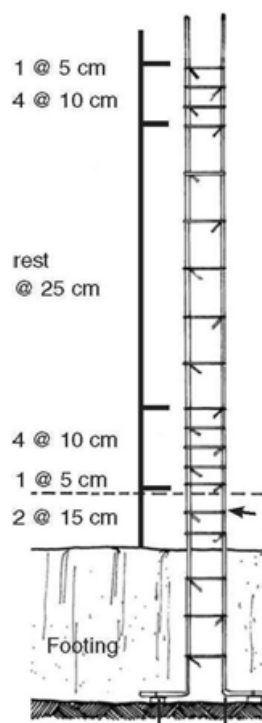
Estribos en las zonas críticas de un pilar (Totten, 2010)
